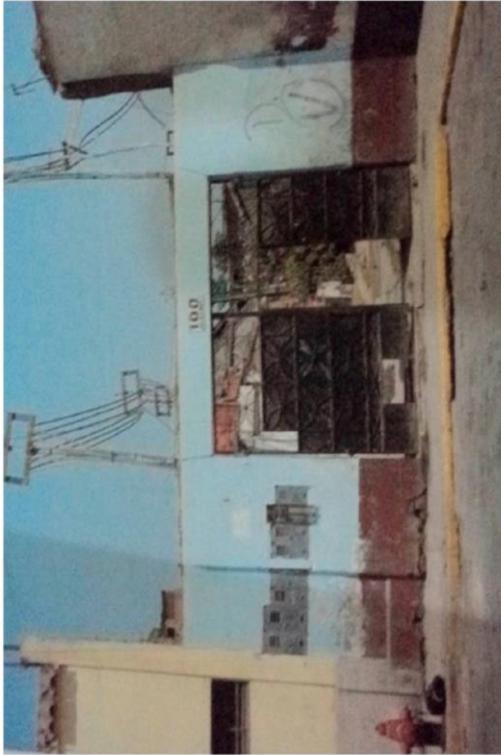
Fachada del inmueble Jr. Cañete 100 (2004)
